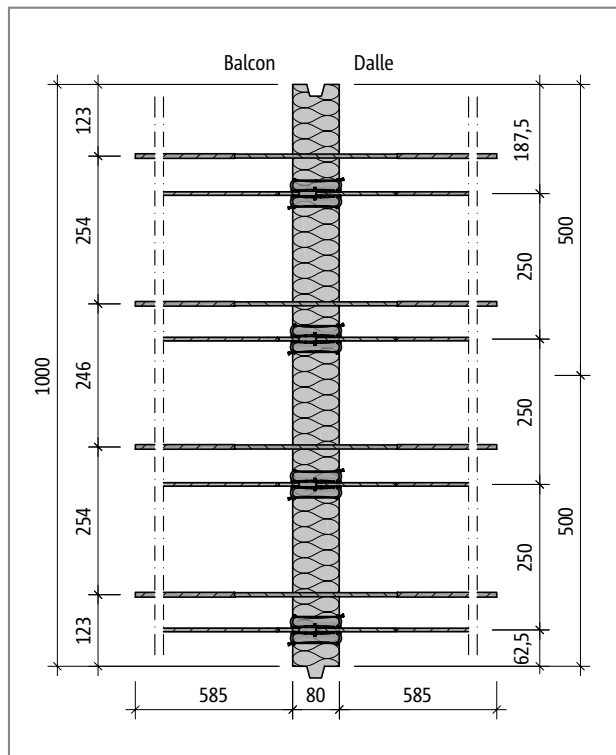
Schöck Isokorb® T Type K-T-M1 : Plan de base du produit
